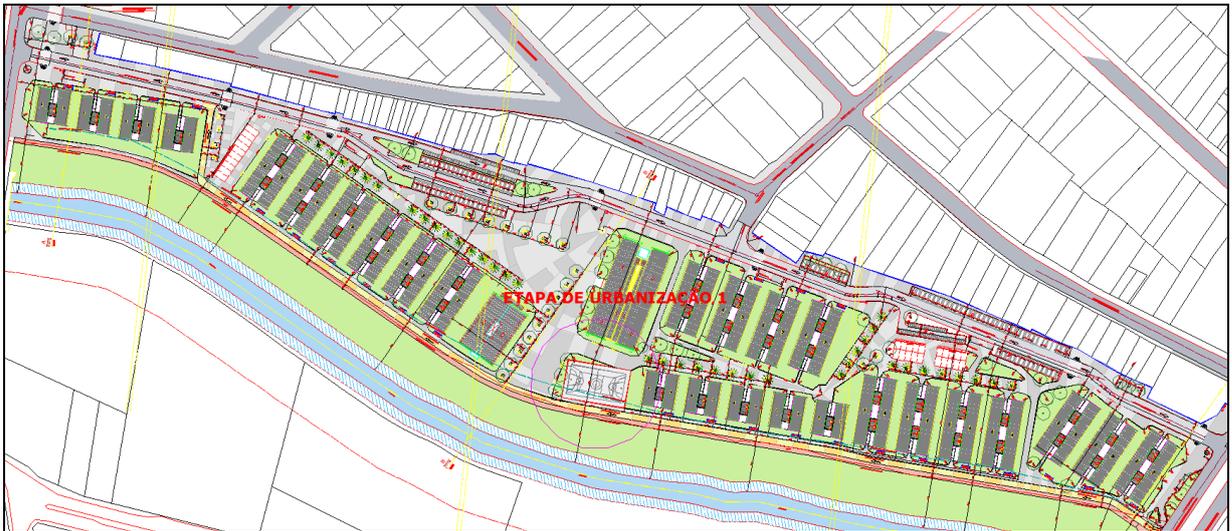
Planta de implantação dos edifícios no terreno (GEPASA).
